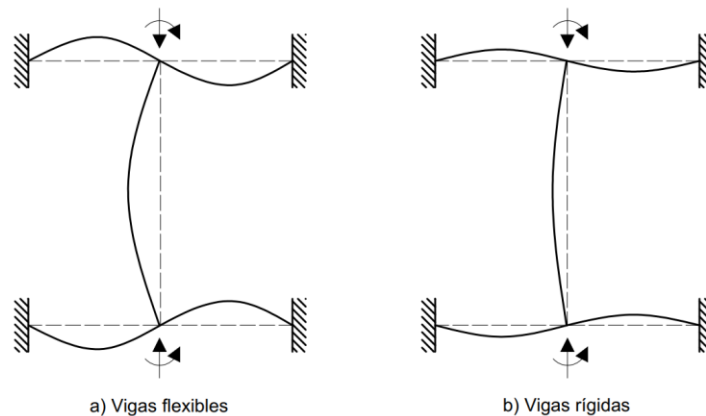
Efecto de rigidez a flexión de las vigas que restringen a una columna.
